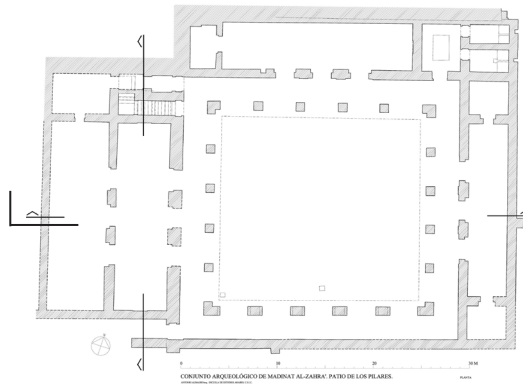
Planta de la Casa del Patio de Pilares, según Antonio Almagro (RABASF, AA-108\_44).
